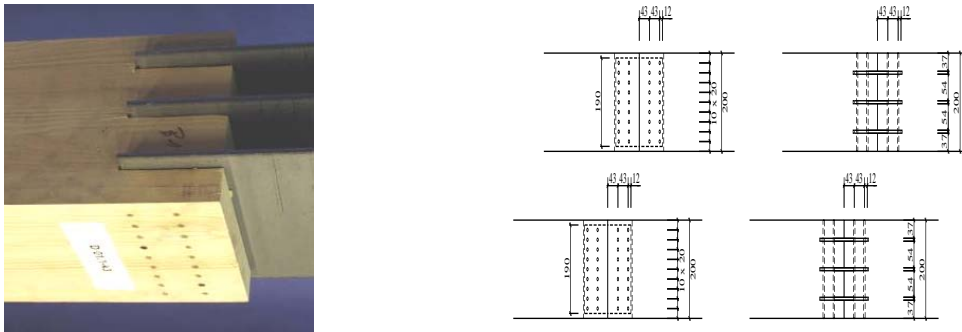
Mehrschnittige Stahl-Holz-Stabdübelverbindung (rechts: Versuchskörper D1.1, alle Masse in mm)
